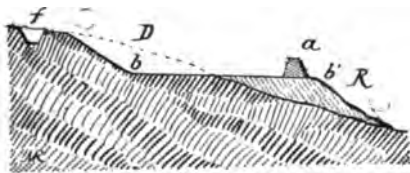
Coupe en travers d'une route en déblai-remblai.
